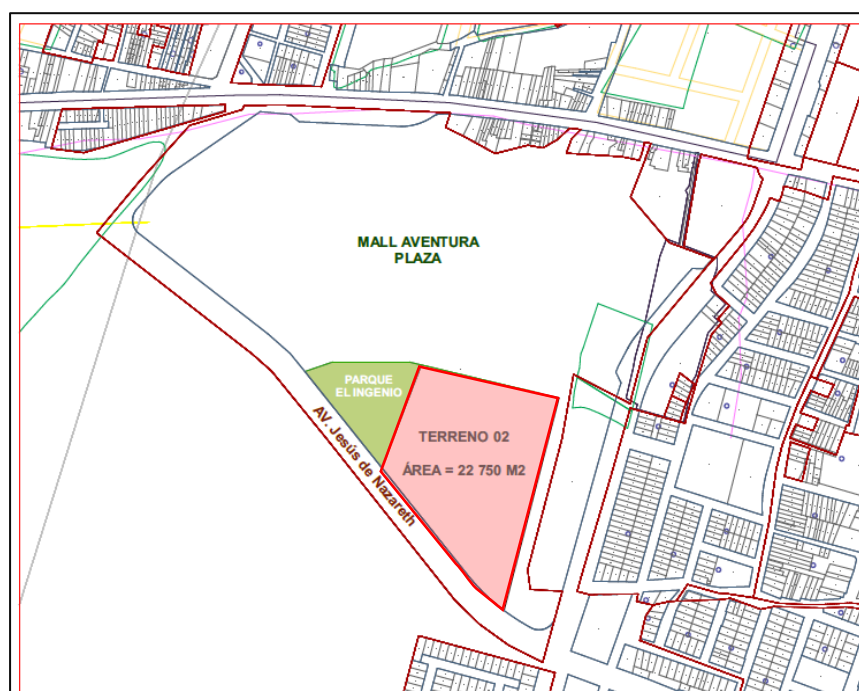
Plano Terreno 02 Fuente: Elaboración Propia
